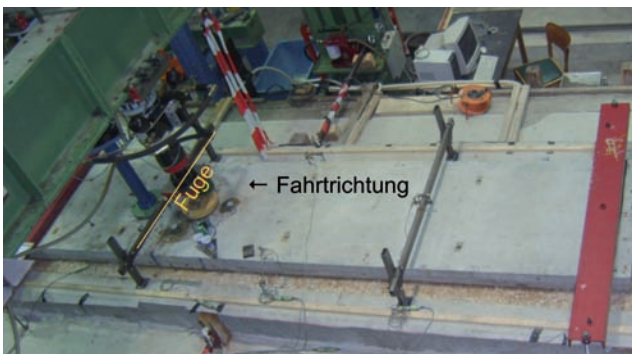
Großprüfstand mit Betonplatte und Messeinrichtungen; an den Fugenrändern gegenüberliegend je ein unabhängig servohydraulisch gesteuerter Prüfzylinder
